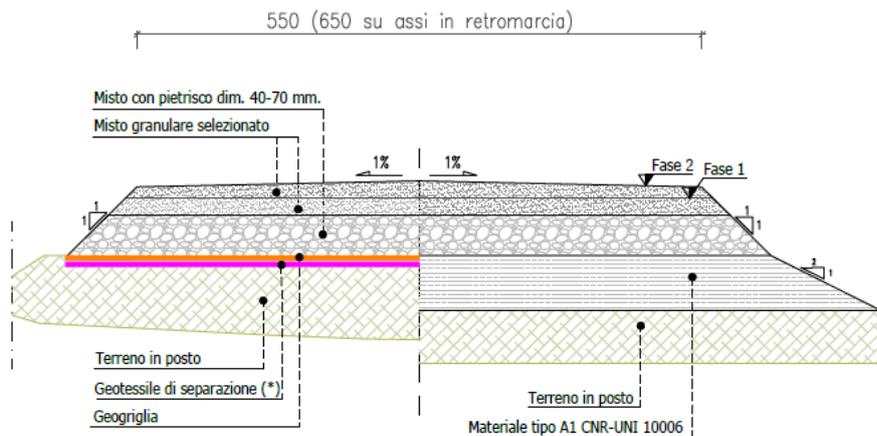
Sezione stradale tratto in rilevato (<13%)
